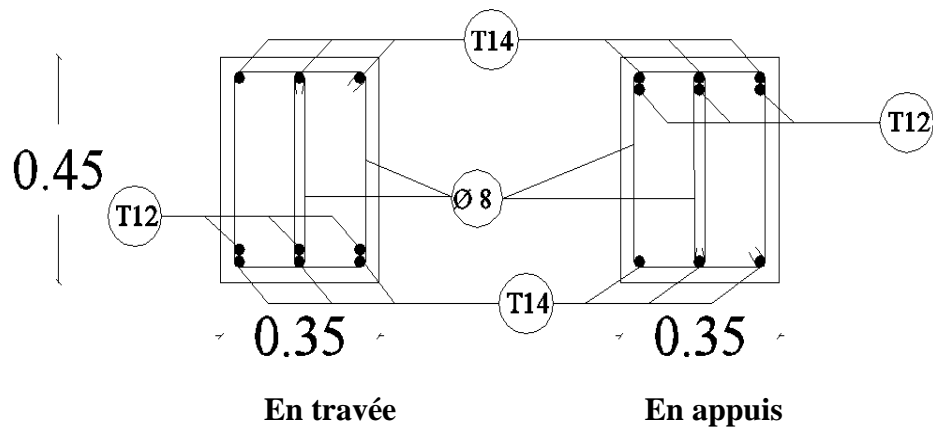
Ferrailage de poutre principale (45 × 35)
